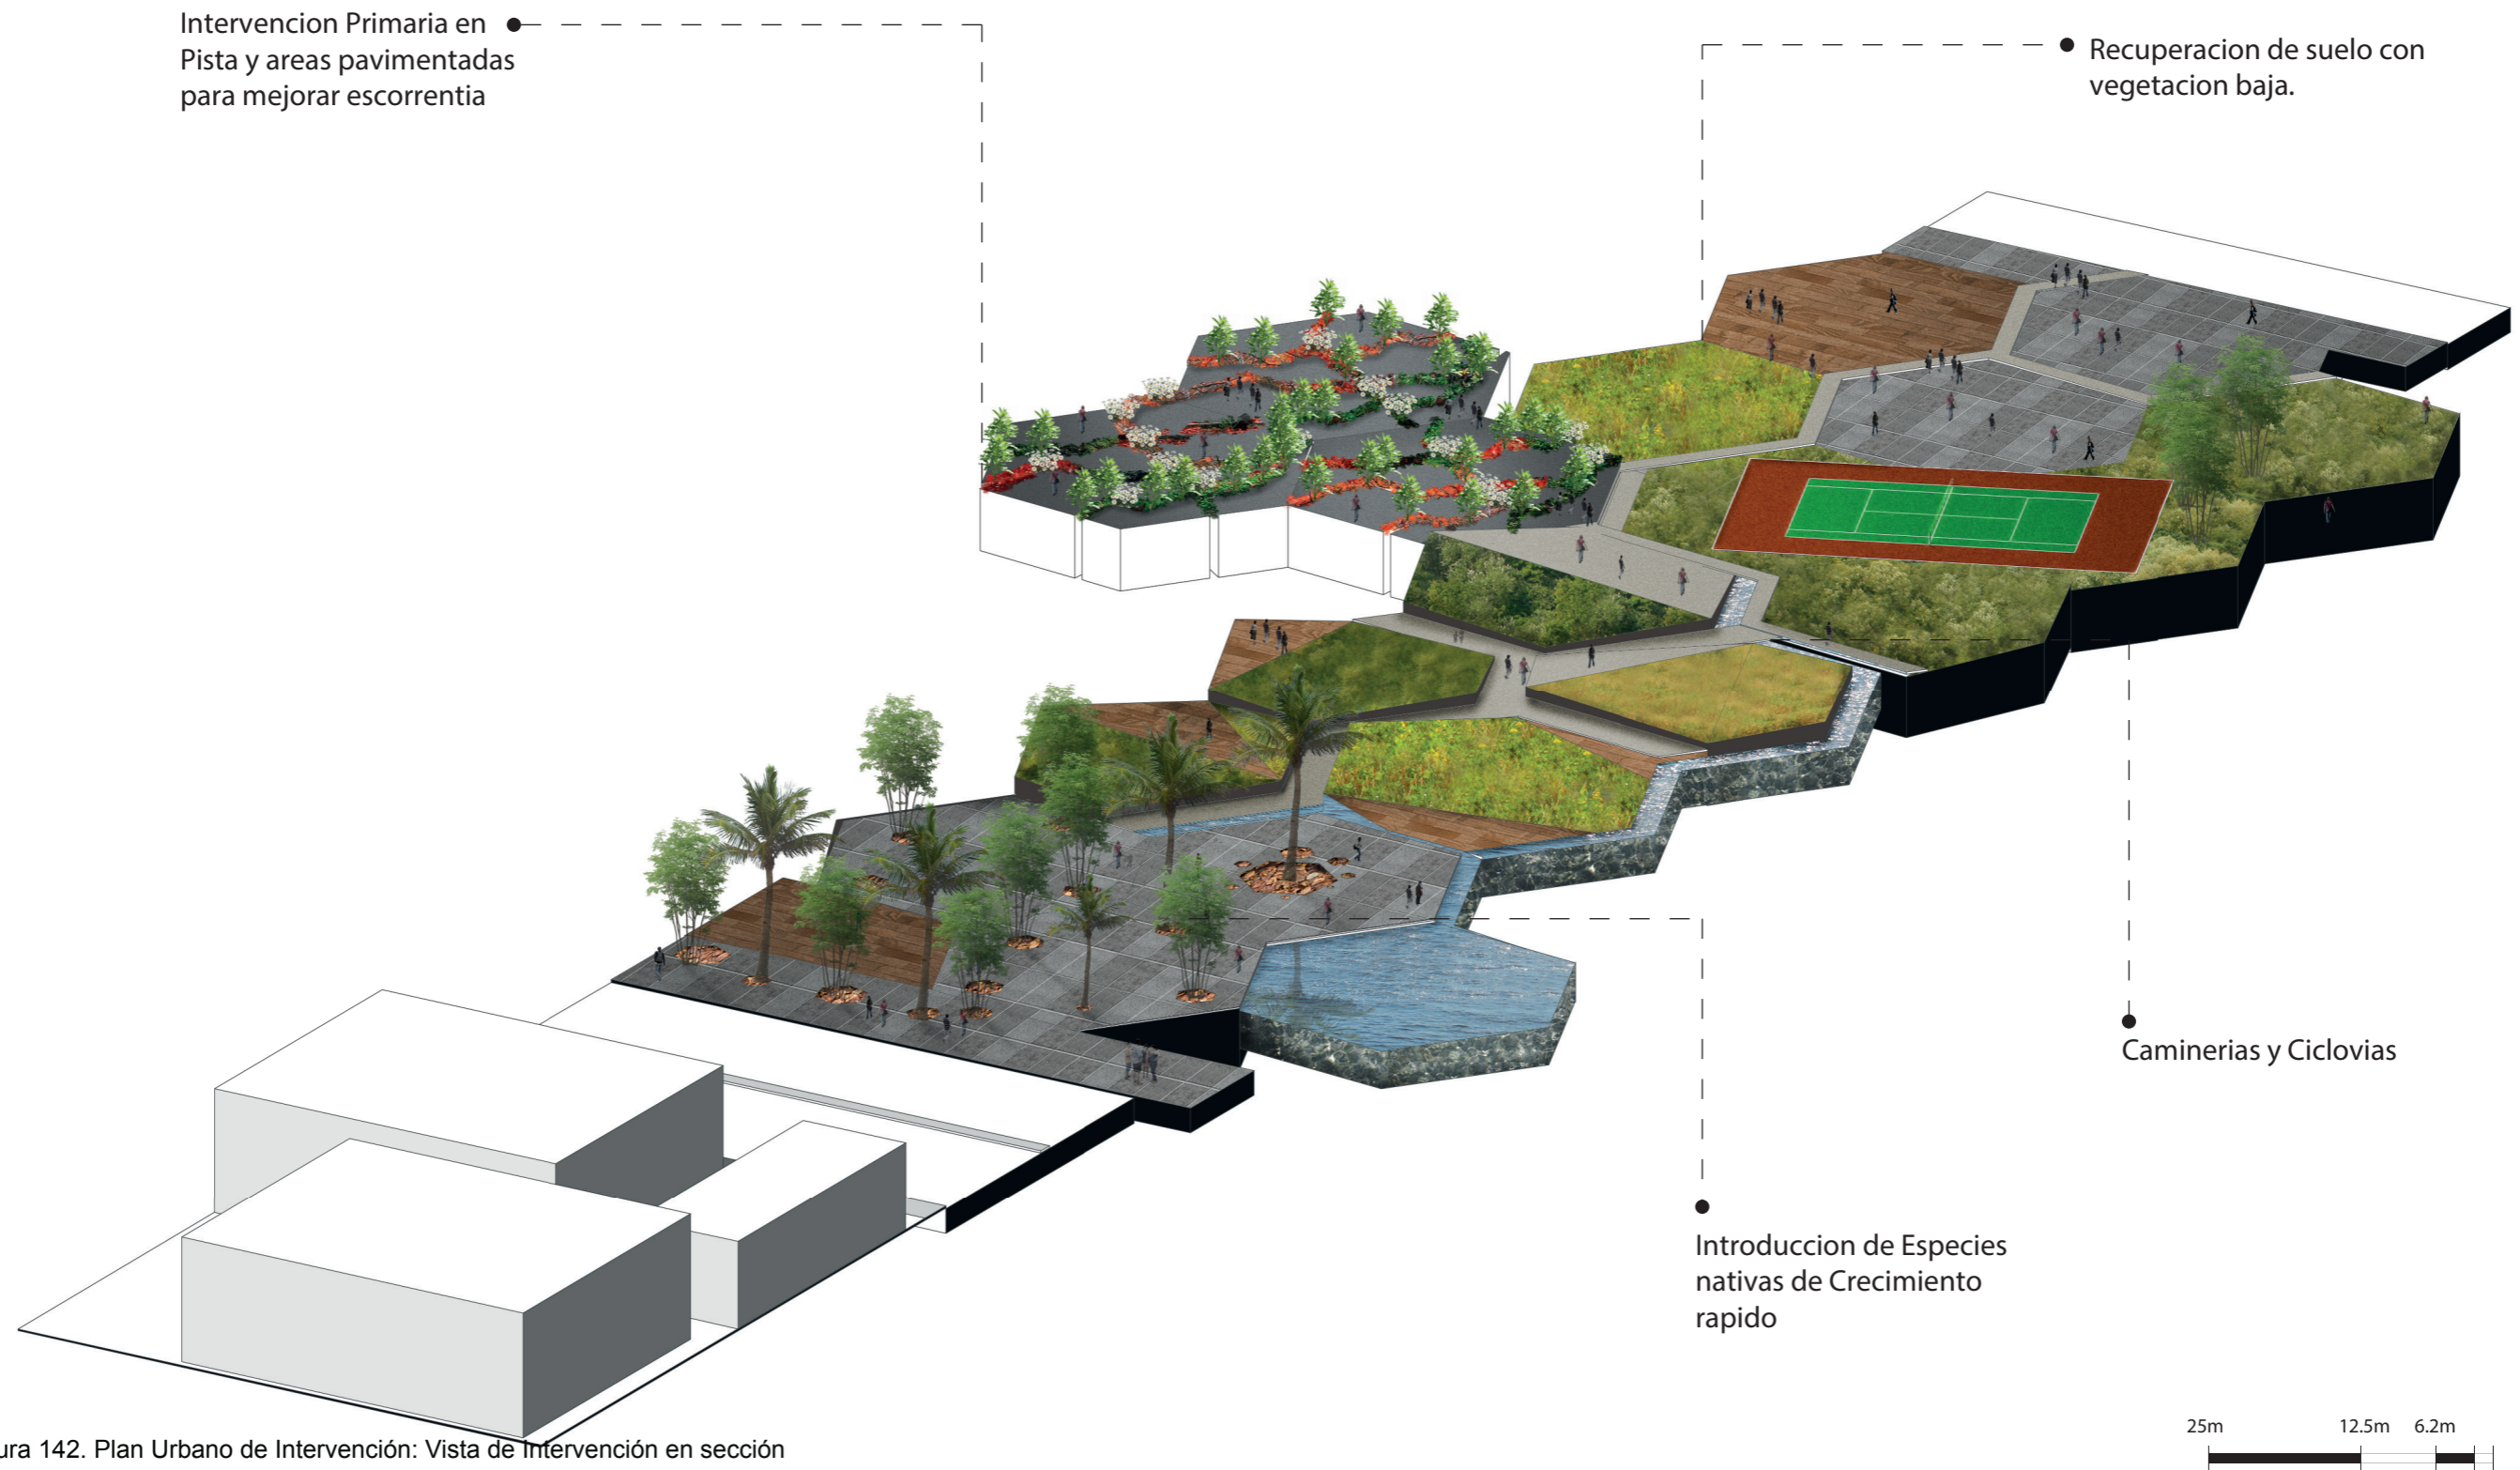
Plan Urbano de Intervención: Vista de Intervención en sección
